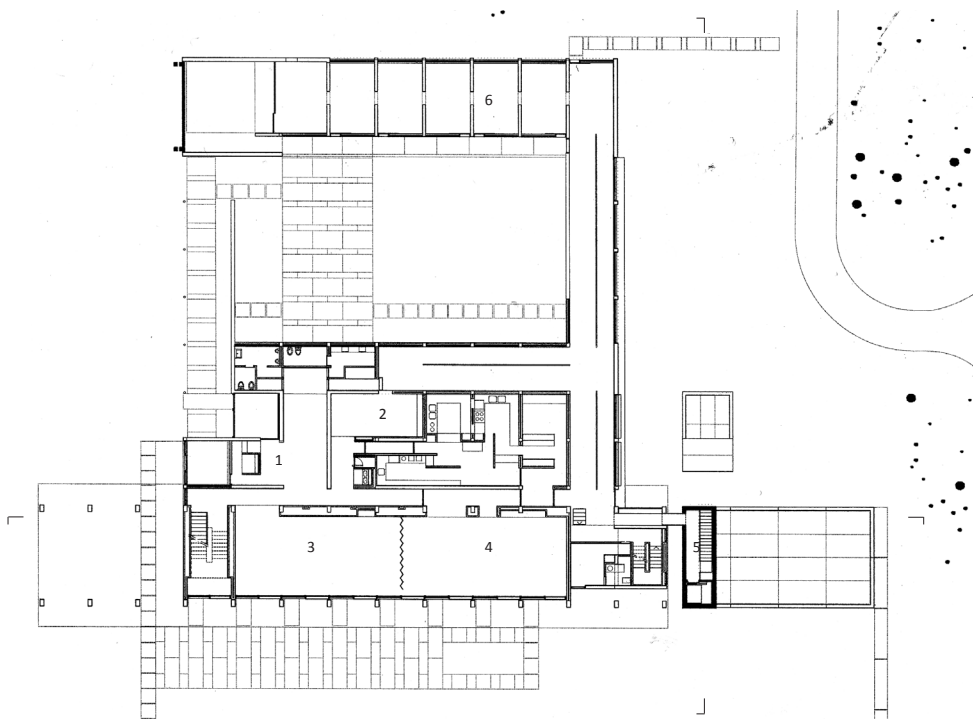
Planta Piso 0 - Primeira proposta de intervenção.
